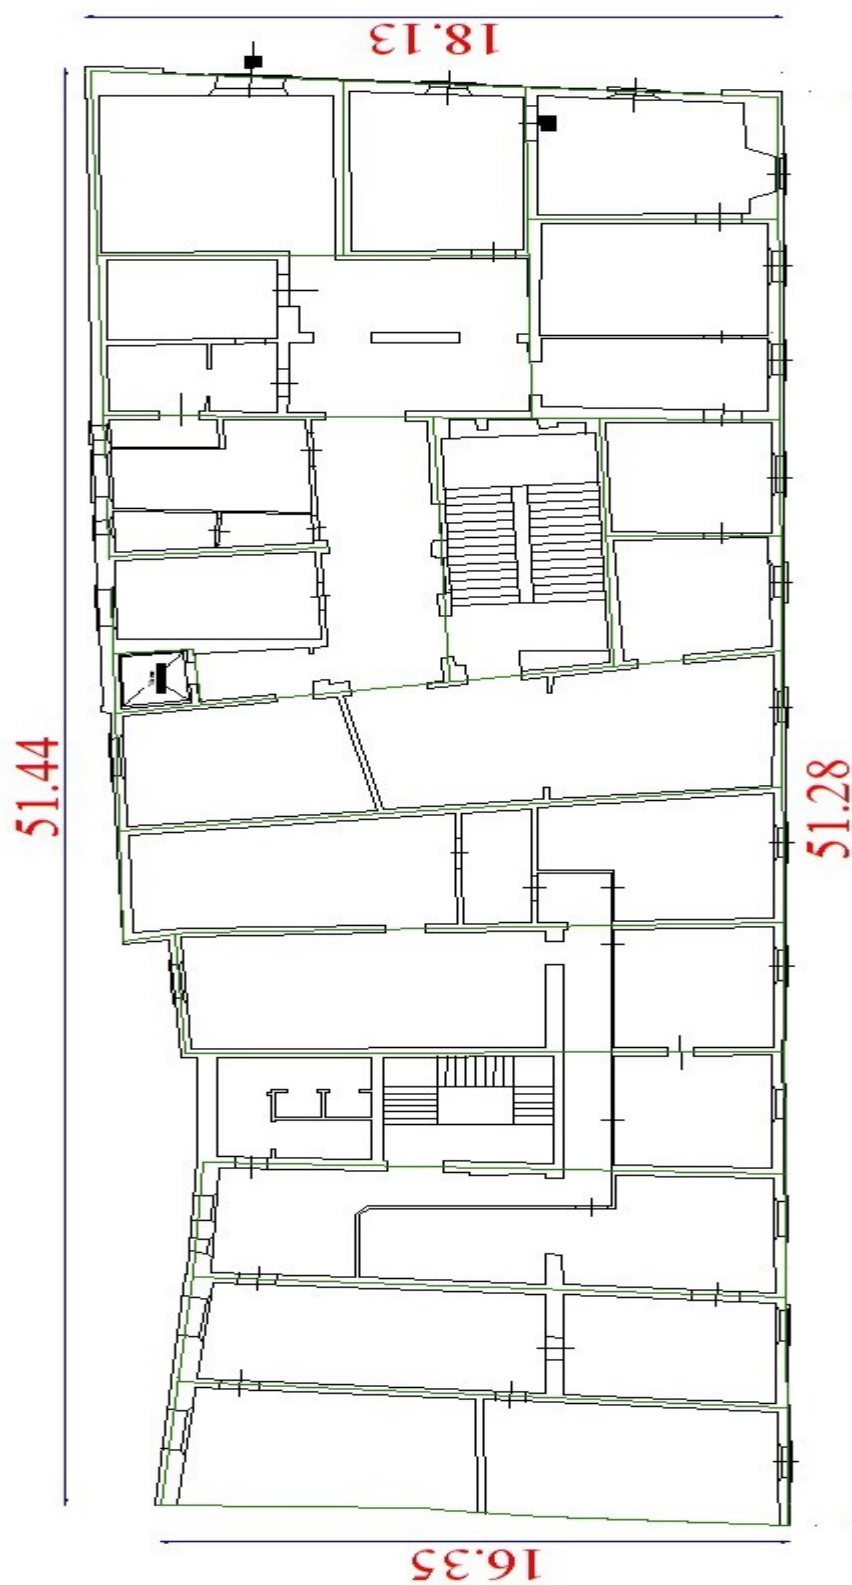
Planimetria piano secondo H.4,20 – (disegno fuori scala)
